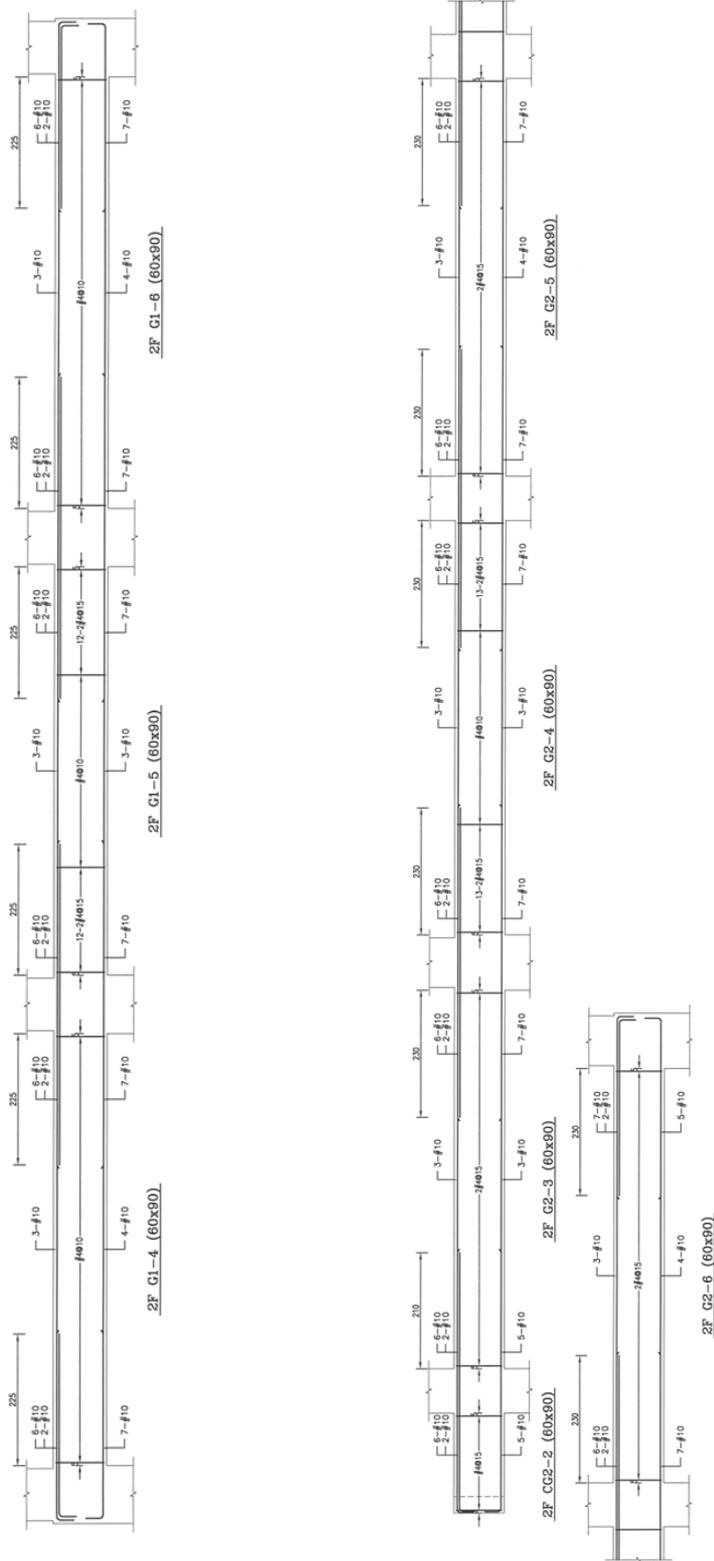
○○市 16 層 RC 公營住宅 RC 梁配筋圖
